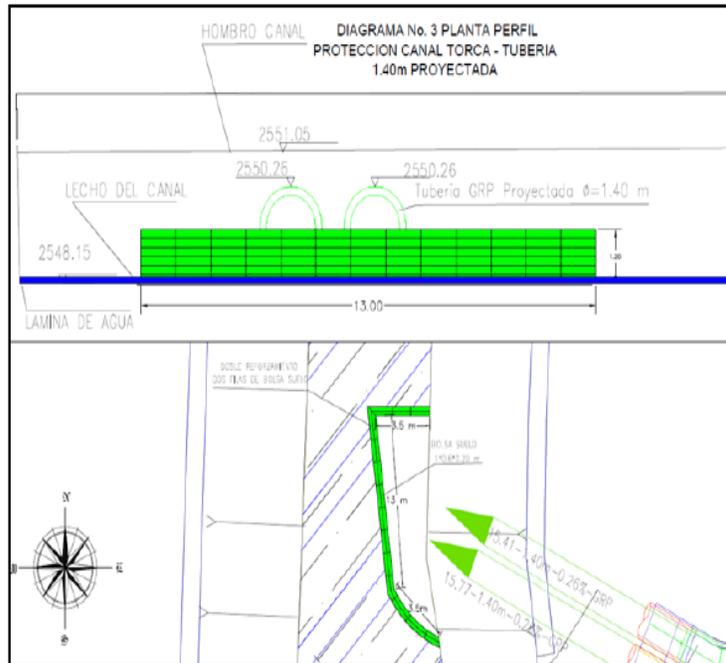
Diagrama planta - perfil de protección del canal Torca – Tubería oriental -1.40.
